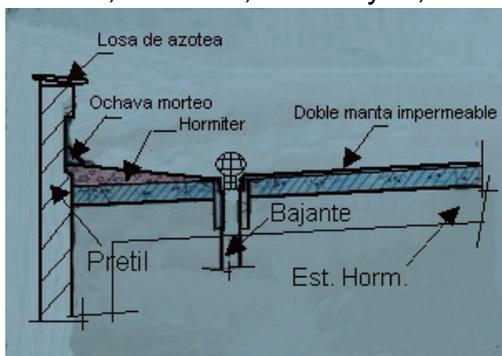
Detalles de la Cubierta con laminas Impermeables. Fuente: El Autor.
